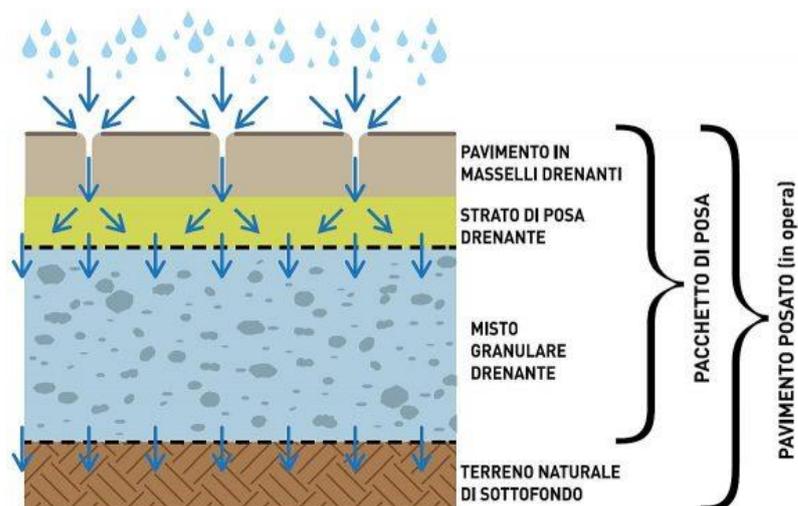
Rappresentazione “pacchetto tipo” di pavimentazione in grigliato drenante
